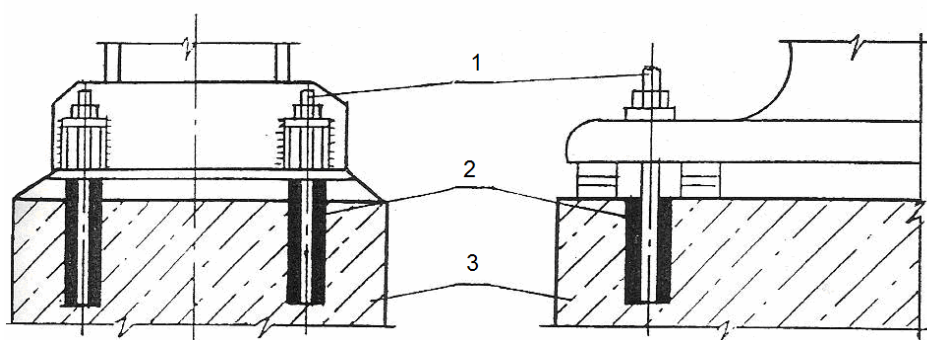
Крепление оборудования к фундаментам при помощи клеевых анкеров:
